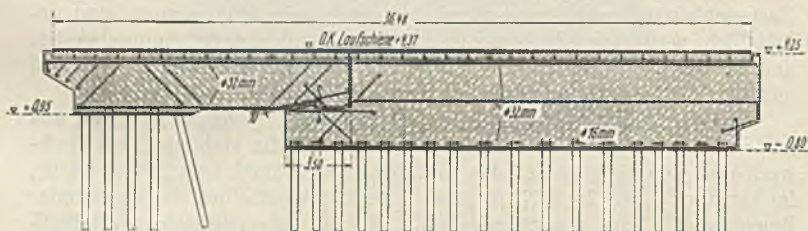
Abwicklung des Laufkranzfundamentes. Schnitt.
